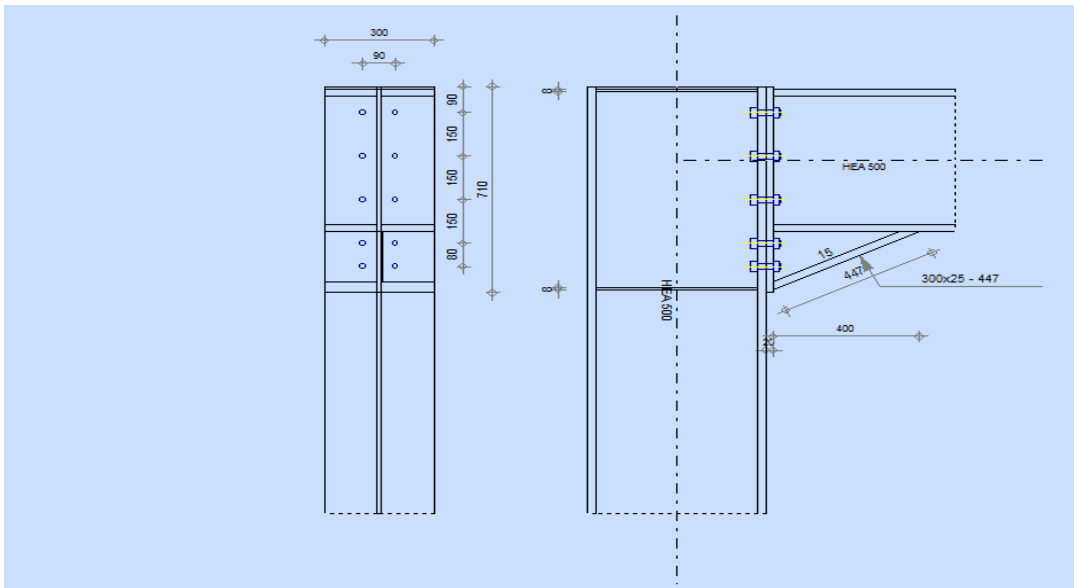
Assemblage poteau- poutre (HEA600-HEA500).
